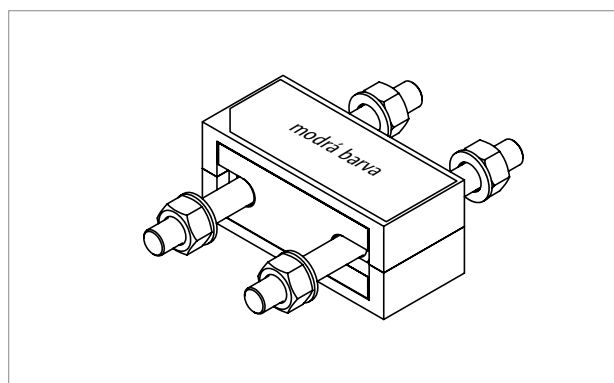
Schöck Isokorb® T typ S-V-D16: Pohled
